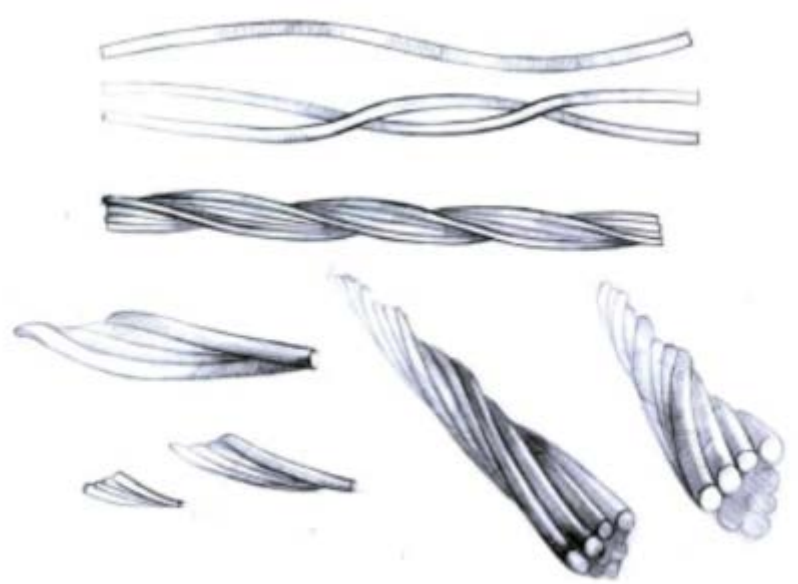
Схемы поперечных сечений трехгранных прядей, применяемых в качестве арматуры преднапряженных железобетонных конструкций:
